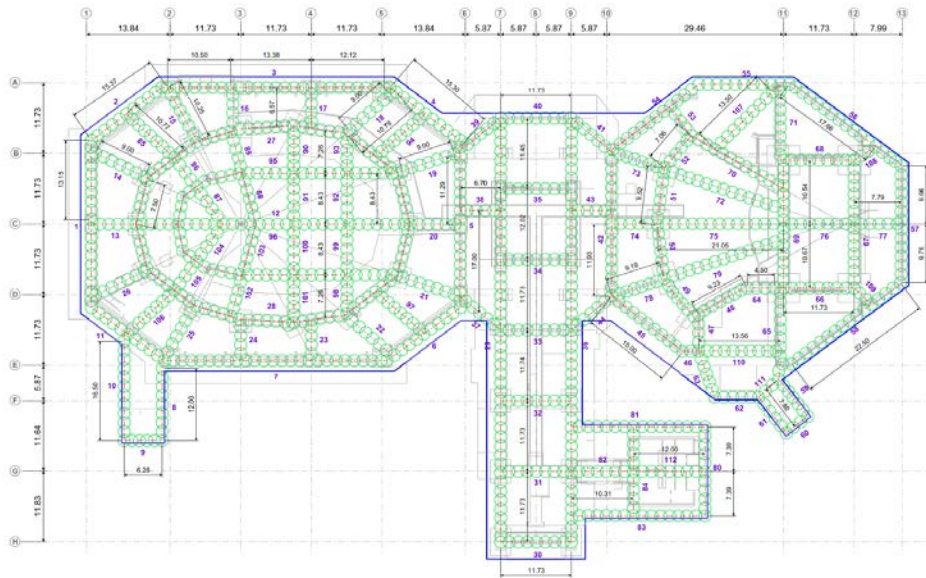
Plan d'implantation des colonnes de jet grouting.
